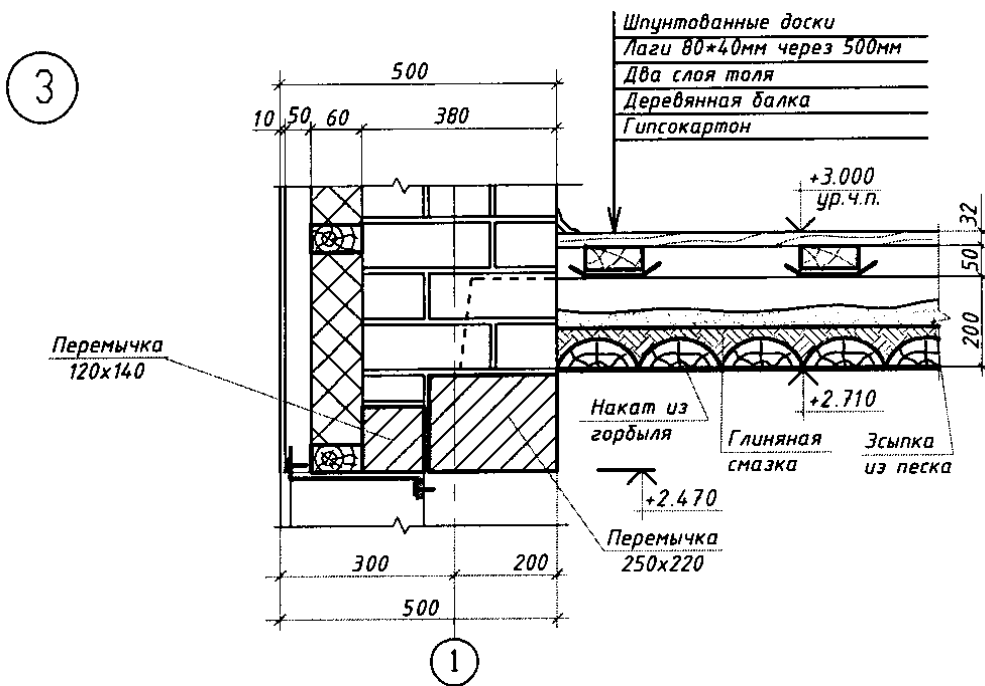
Пример выполнения узла опирания перекрытия на стену
